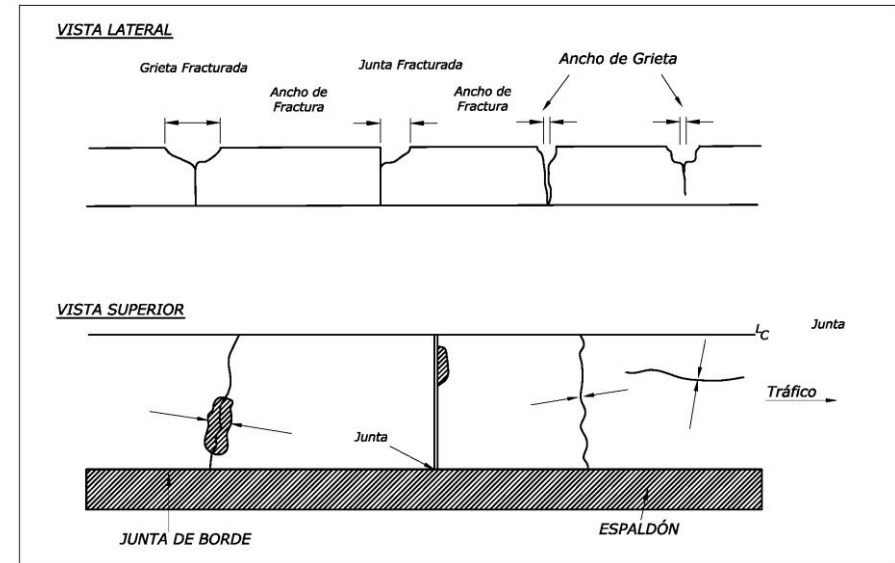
Medida correcta de los anchos de Grieta y Fractura
